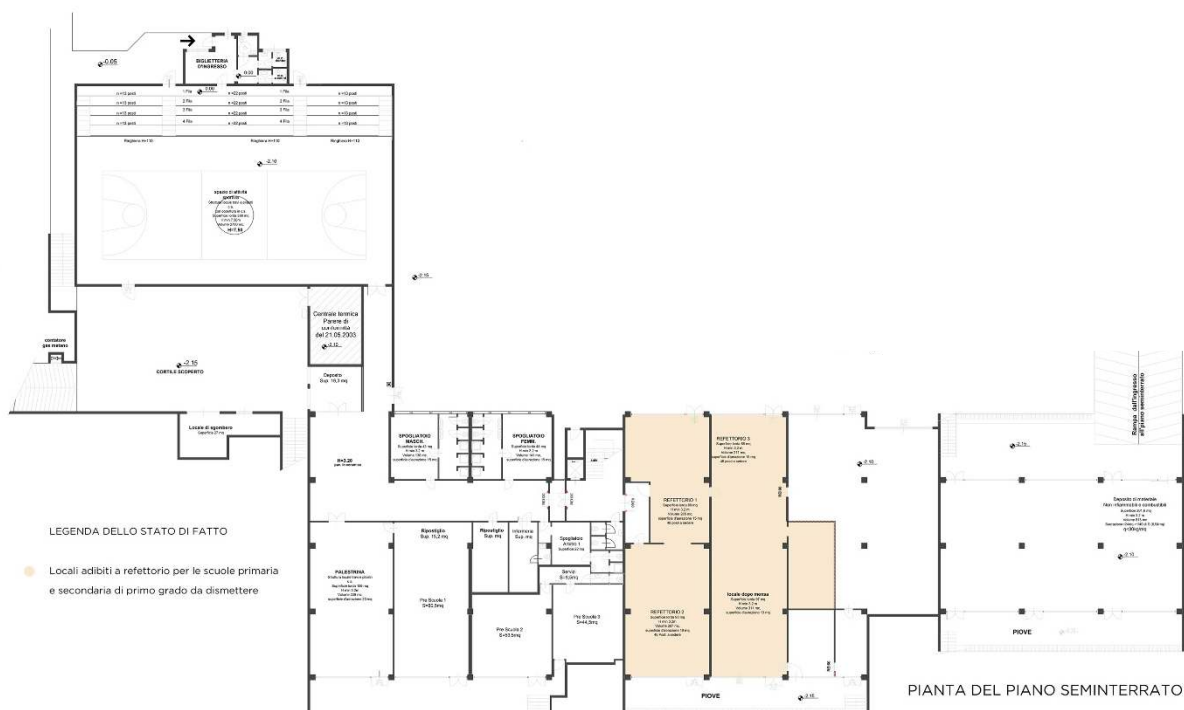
Planimetria del piano seminterrato allo stato di fatto della scuola con individuazione della mensa.
